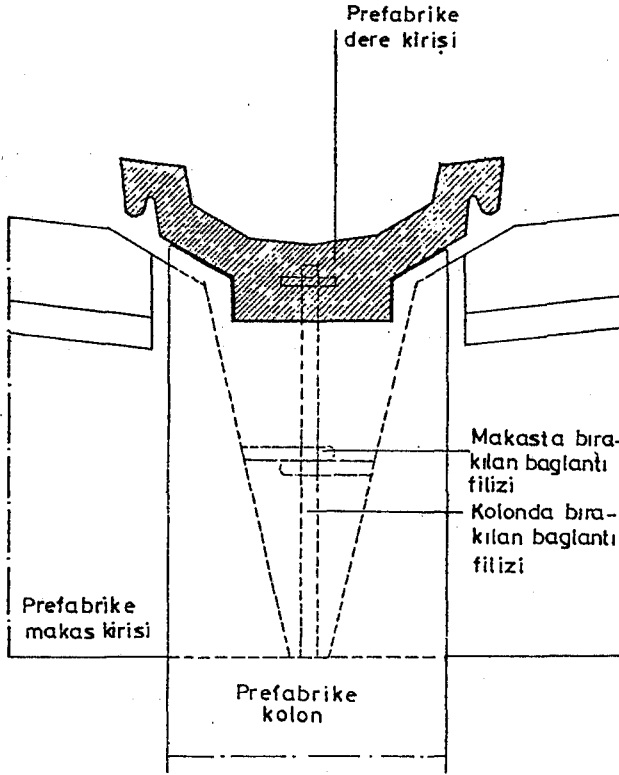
kolon - makas kiriş ve dere kiriş birleşim detayı
